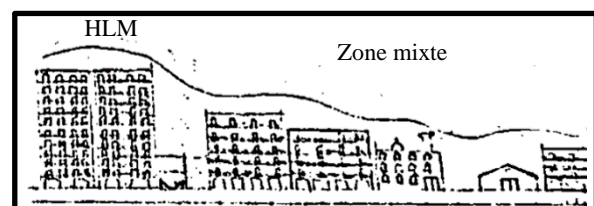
Façade nord de la rue Belouizdad. (Source : Auteur)
